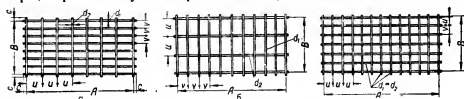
Сварные сетки с рабочей арматурой, расположенной: а — в направлении большего размера сетки, б — в направлении меньшего размера сетки, в — в обоих направлениях
